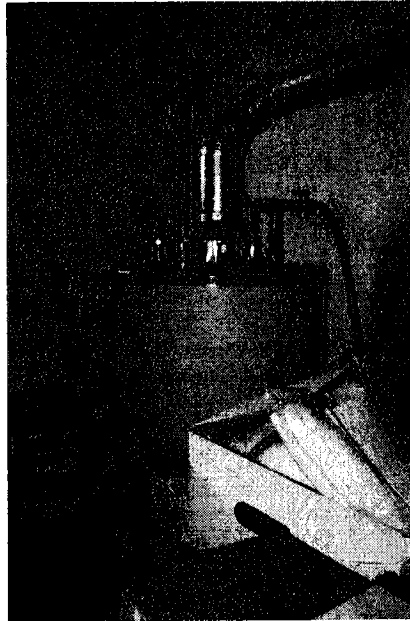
Untergeschoss, Boiler ausschließlich (nur) für das Bewertungsobjekt, Wohnung SE 2
